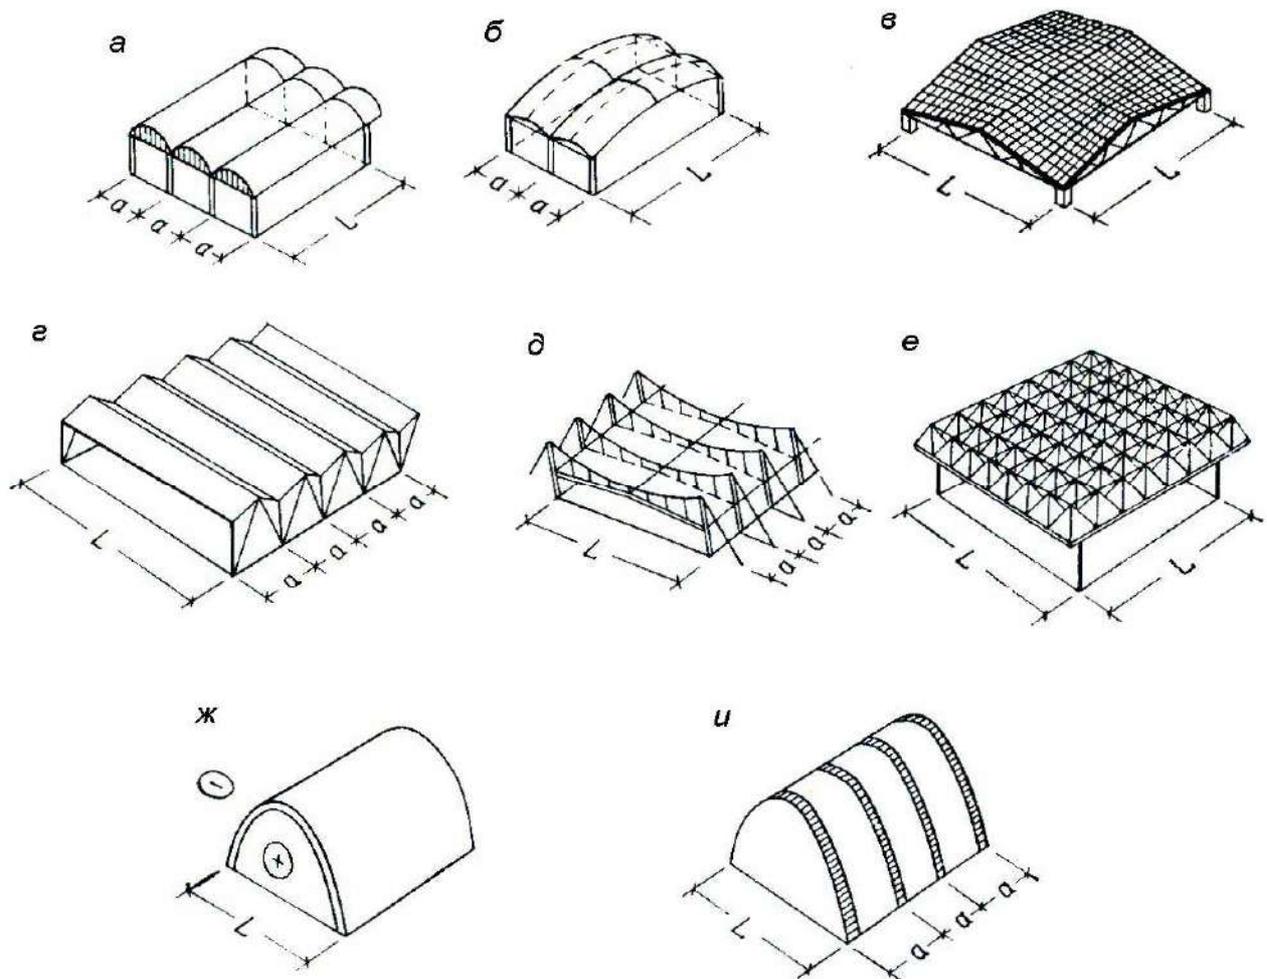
Конструктивные схемы покрытий каркасных промышленных зданий.
